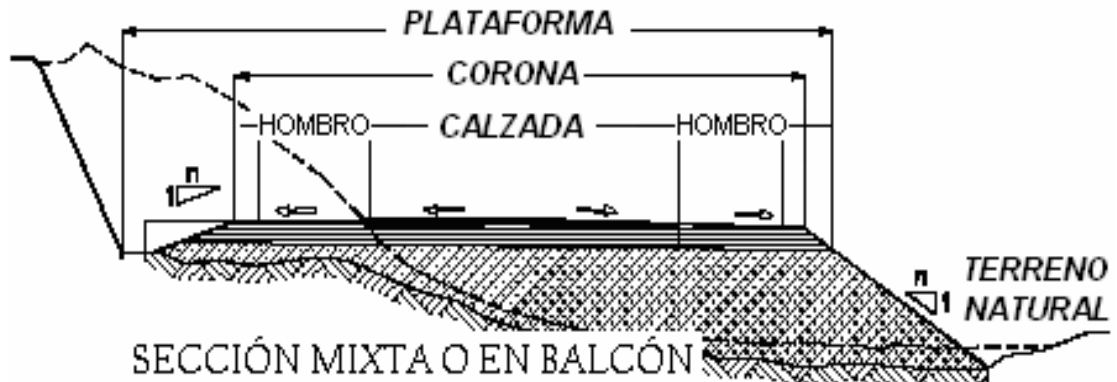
Perfil de la sección transversal mixta o en balcón.
